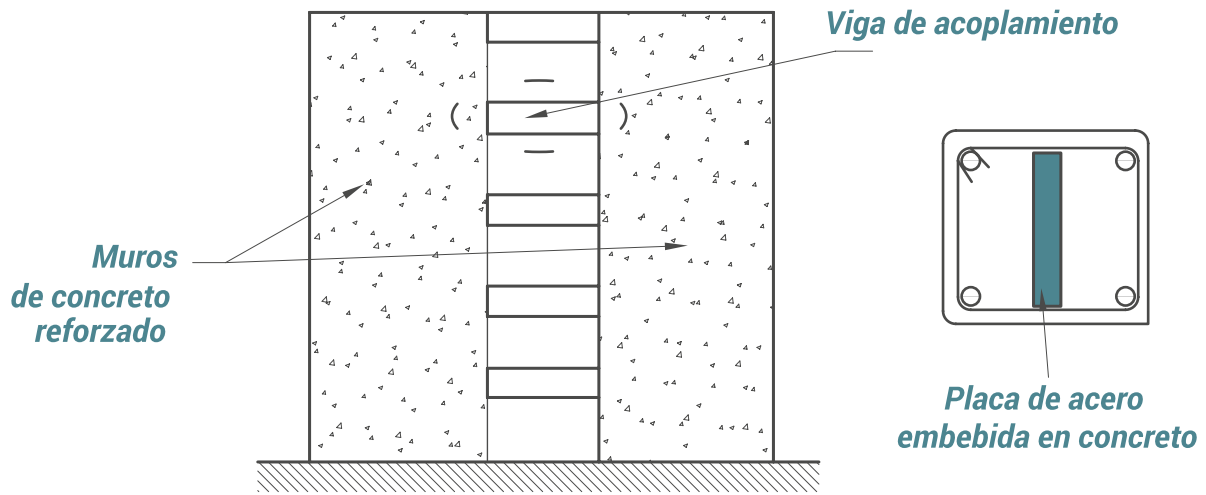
Muros de concreto reforzado con vigas acopladas compuestas.
